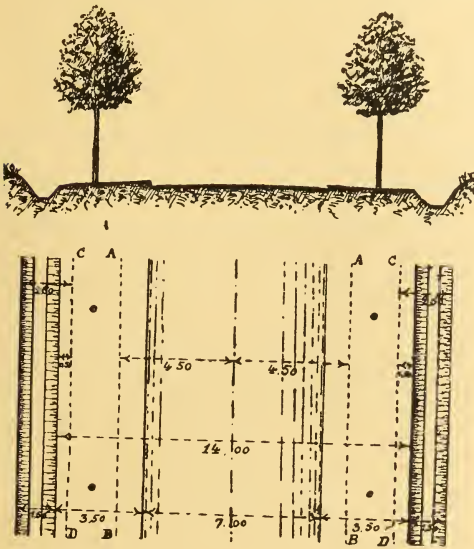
Plantations sur une route de plus de 10 mètres de largeur.
